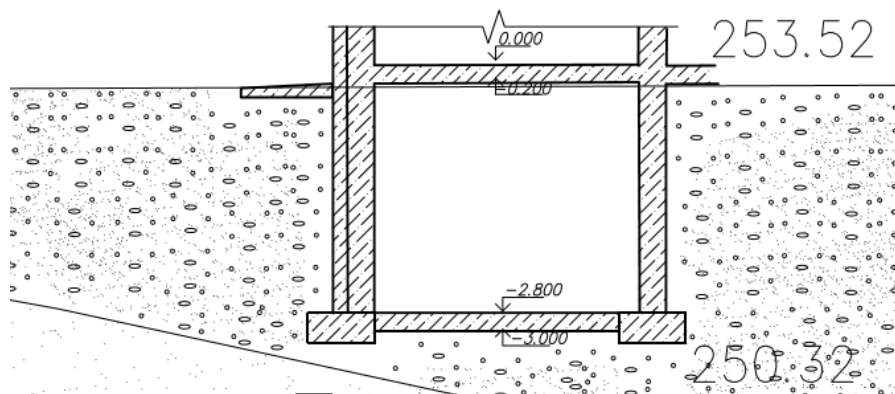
Столбчатый фундамент с устройством подпорной стены
